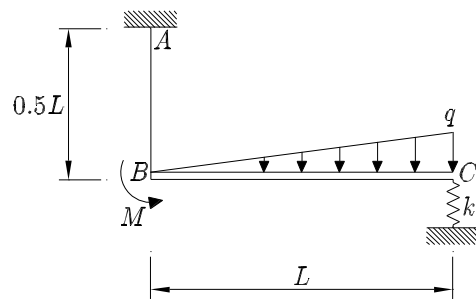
Estructura hiperestática de dos barras con apoyo elástico
